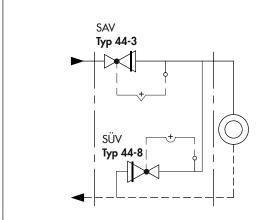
Absicherung einer Hausstation mit SAV Typ 44-3 und SÜV
